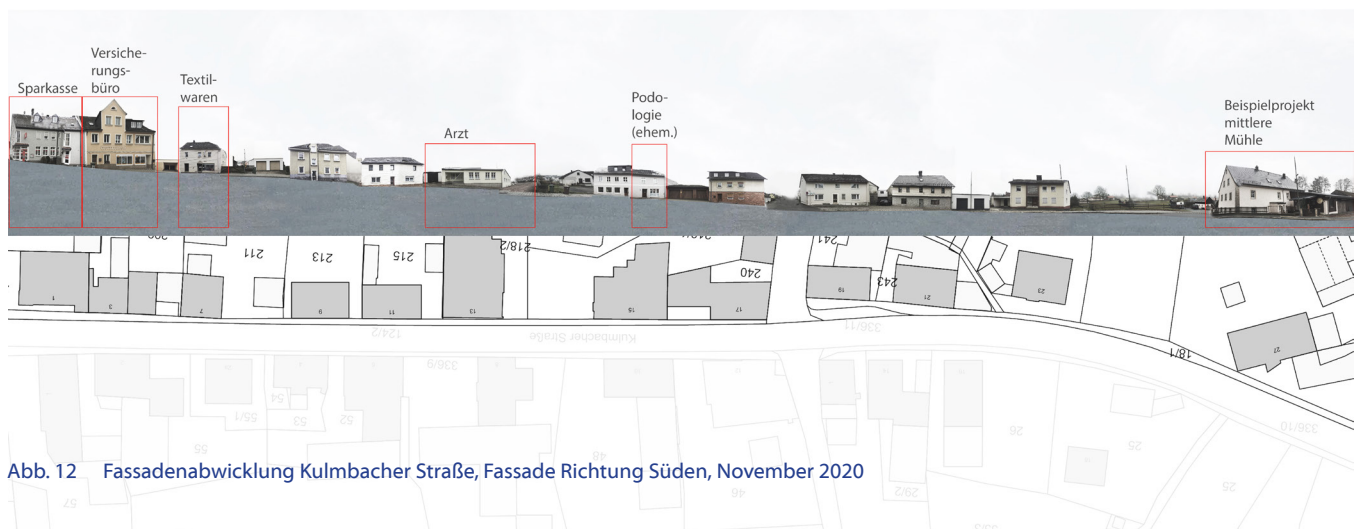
Fassadenabwicklung Kulmbacher Straße, Fassade Richtung Süden, November 2020
